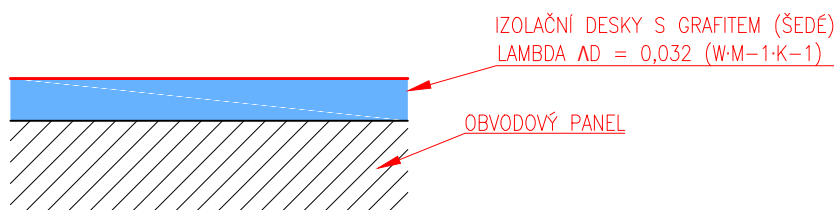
DETAIL ZATEPLENÍ OBVODOVÝCH STĚN 1.–4.NP
